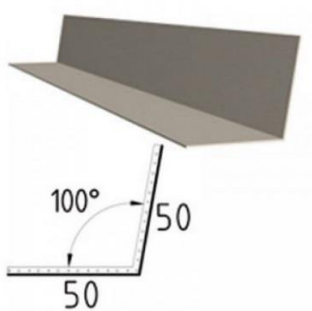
Detailová tvarovka Dekplan vnější roh [33]
